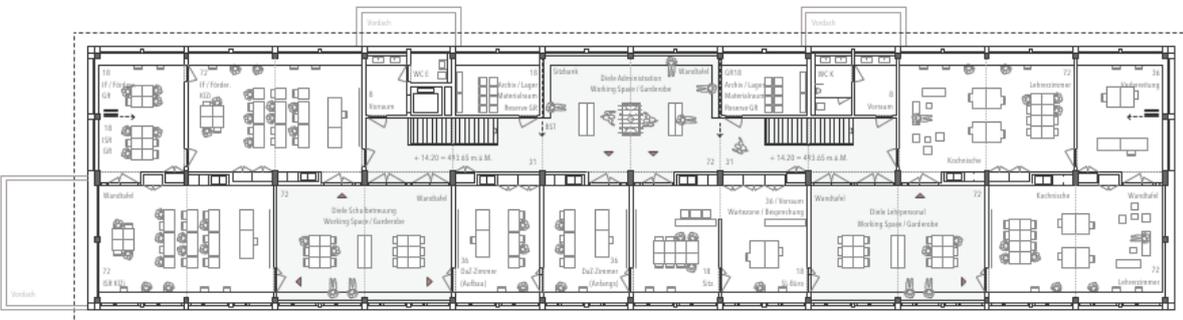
Neubau Sekundarschule, Grundriss 4. Obergeschoss
